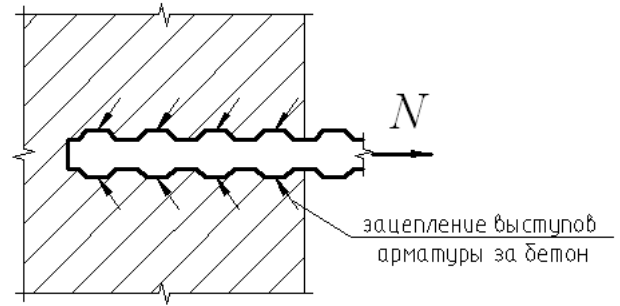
Сцепление арматуры периодического профиля с бетоном.
